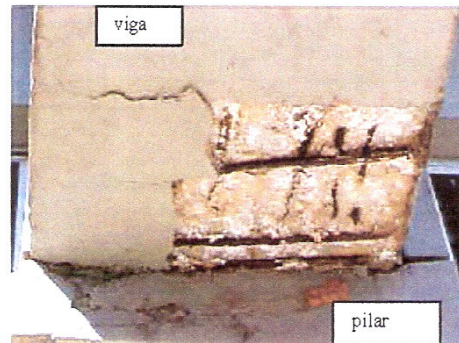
sinais de esmagamento no concreto do pilar (Fi=3) e corrosão na viga (Fi=4)
